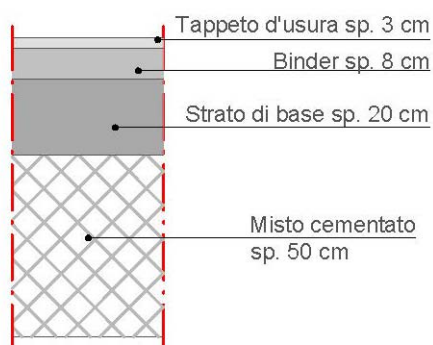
Particolare della pavimentazione della strada statale e della rotatoria
